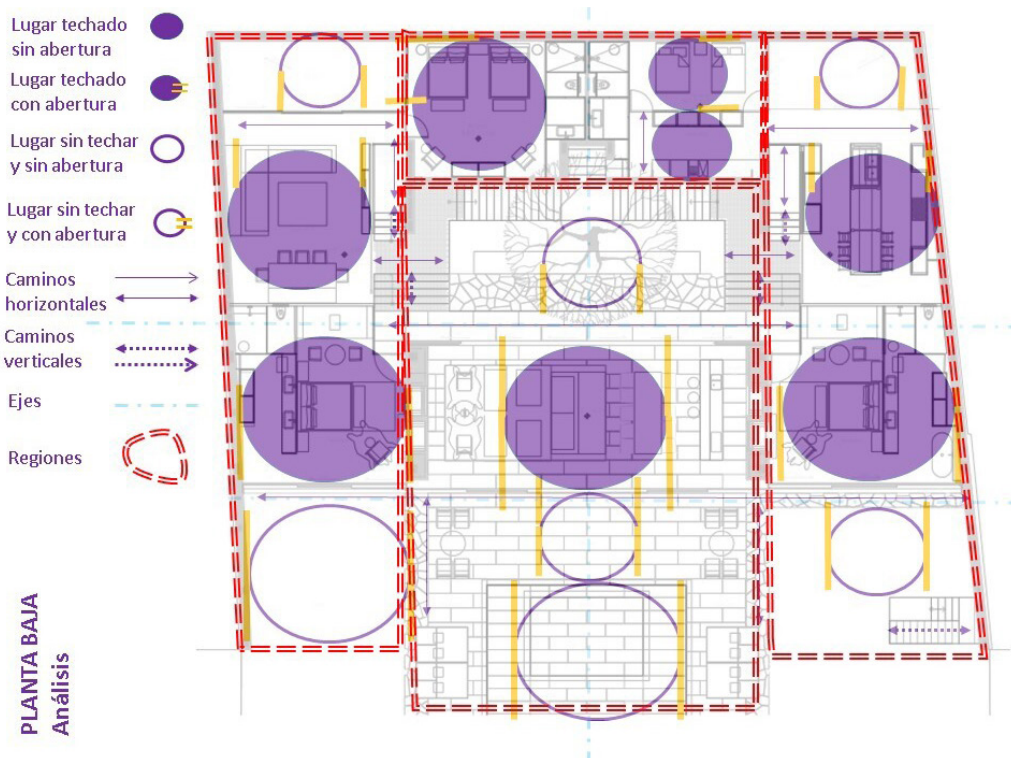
Análisis de planta baja. Plano base del archivo de Mónica Ledezma. Reproducida con permiso de la autora Mondragón Ruiz (2023).
